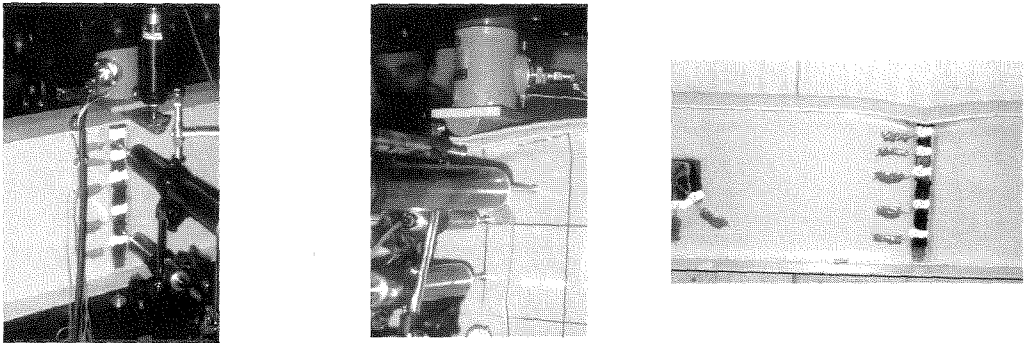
Viga V1 – Início, fase intermédia e após ensaio
